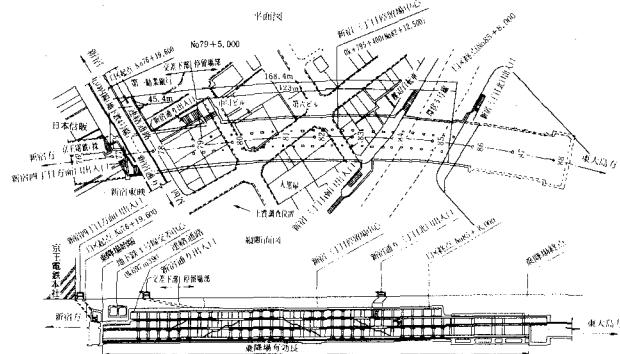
都営地下鉄新宿線新宿三丁目駅部平面縦断面図
